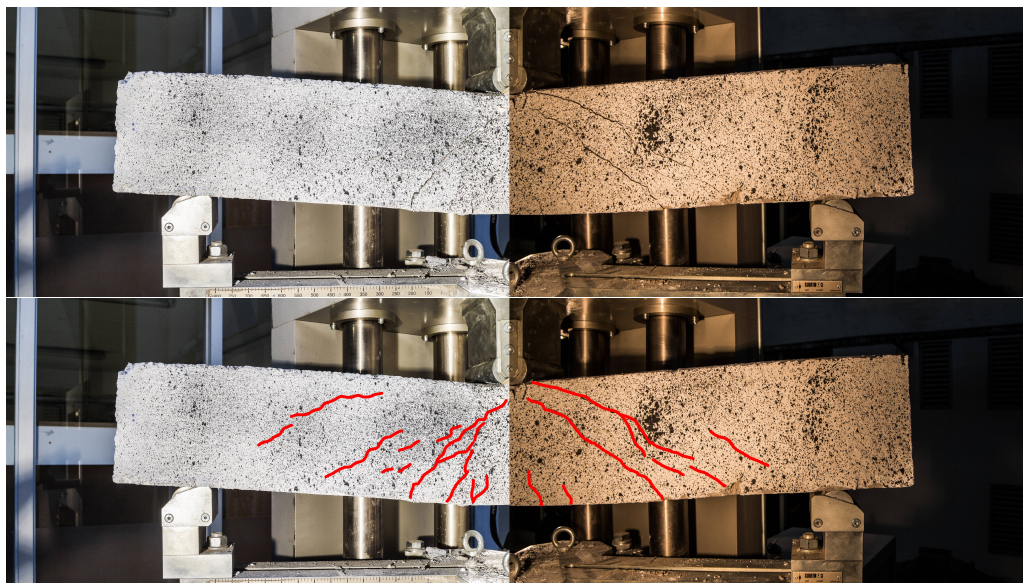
Agrietamiento en la viga 2 al finalizar el ensayo de carga-deformación.
